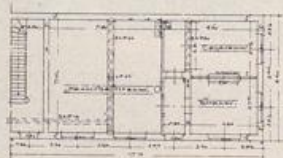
Dienstgebäude. Münsterstrasse. Erdgeschoss. 1:500.
